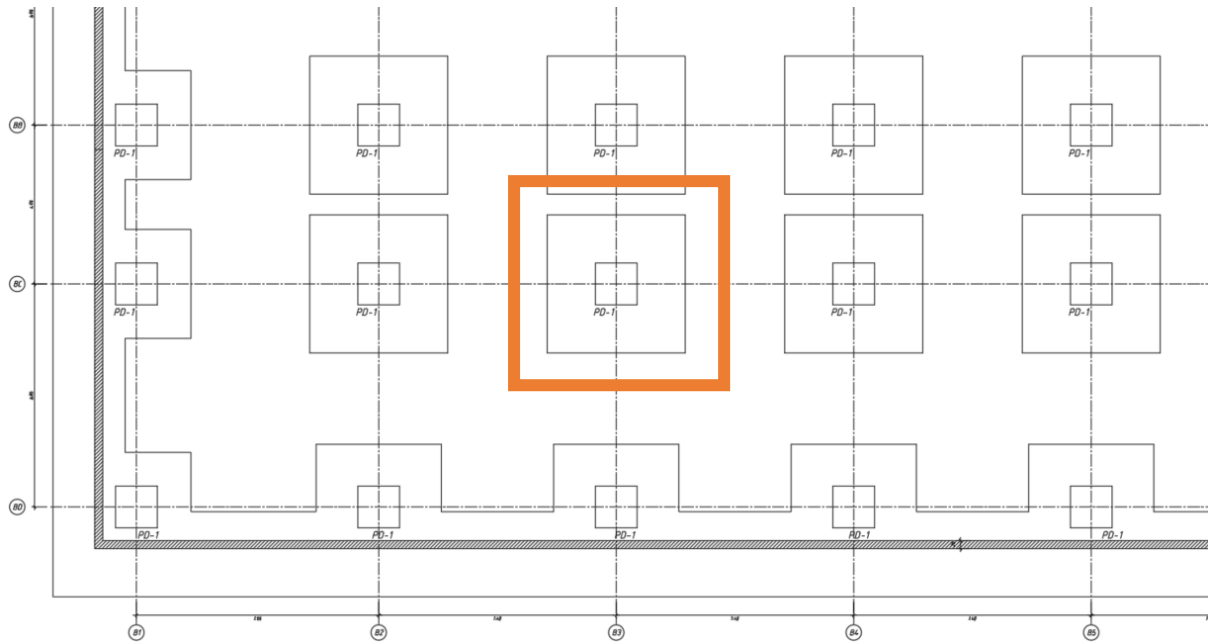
Vista en planta de la zapata elegida para ejemplo de diseño
